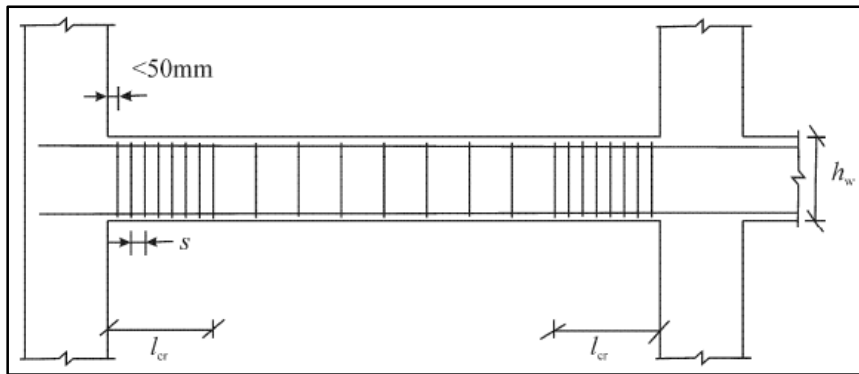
Armaduras transversais nas zonas críticas das vigas [7]
